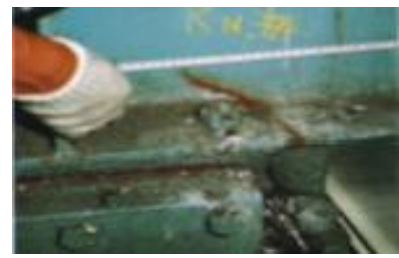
ソールプレート取付け部の溶接部のき裂
